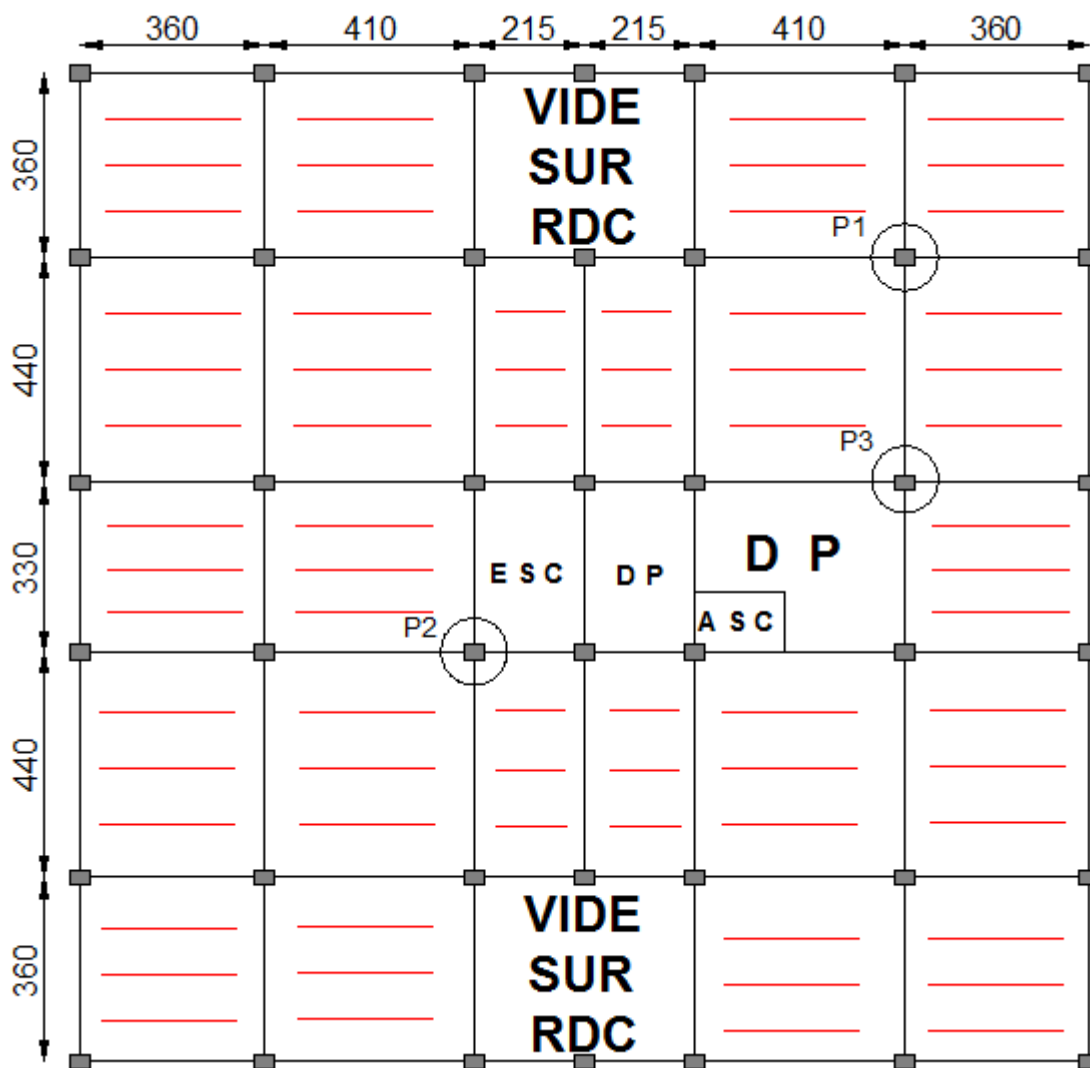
Schéma de la disposition des poutrelles de l'étage 1 jusqu'à l'étage 6.
